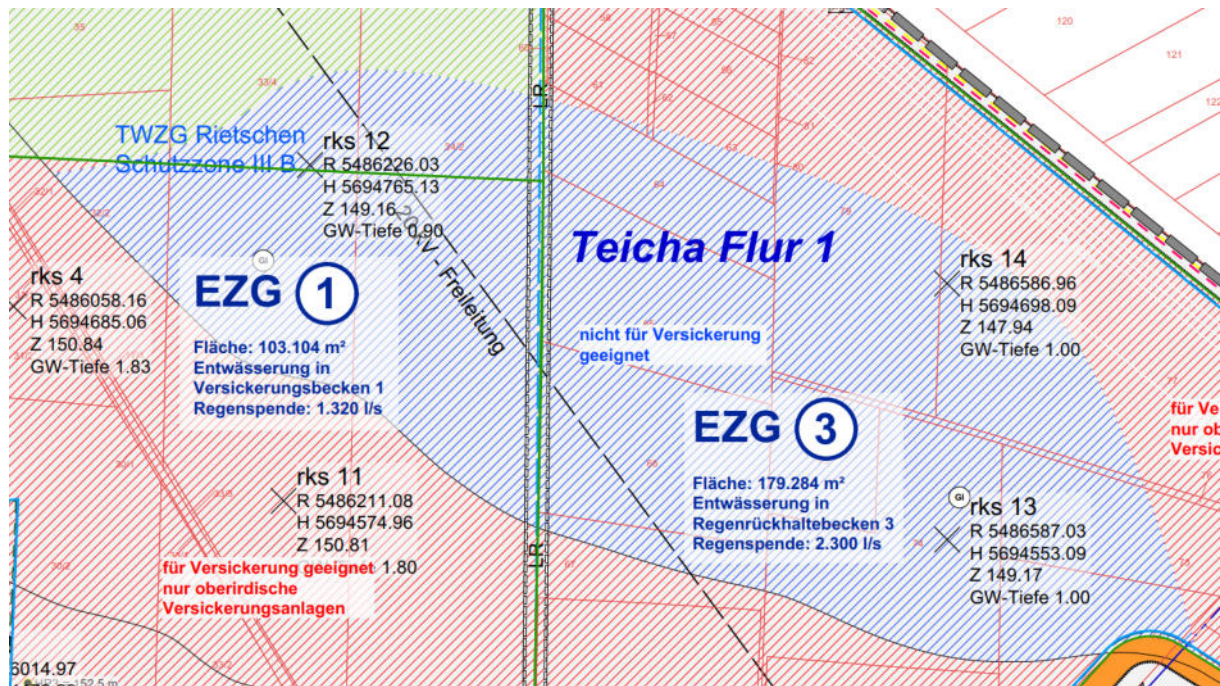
Lageplan mit der Fläche mit hohem Grundwasserstand
